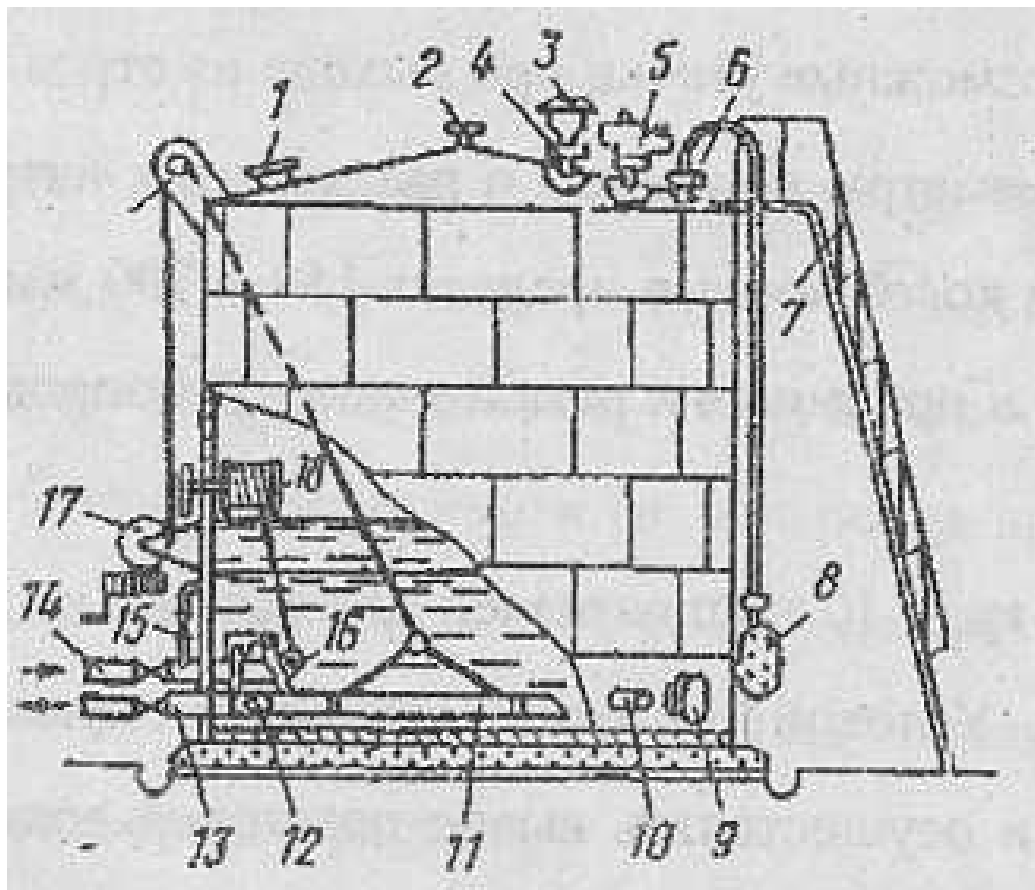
Схема расположения оборудования стальных вертикальных цилиндрических резервуаров
